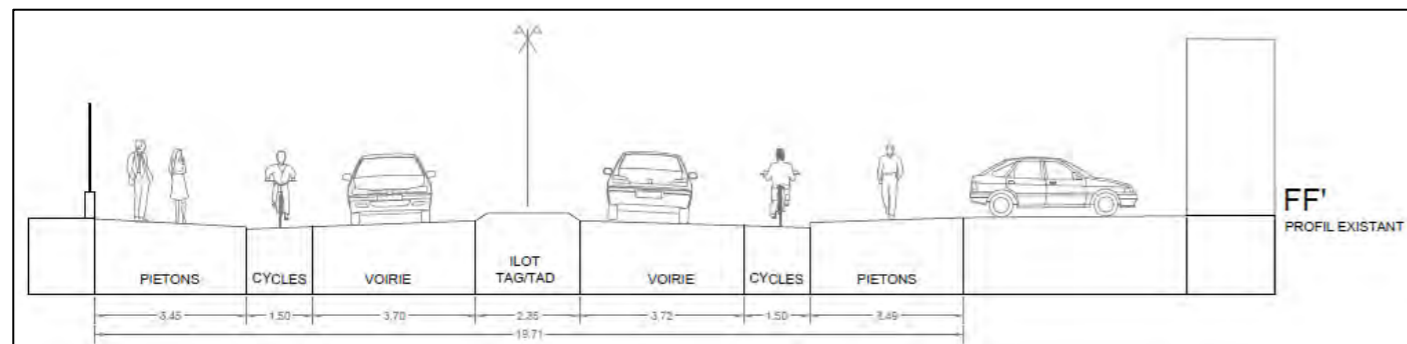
Profil en travers type existant entre la rue du Professeur Villemain et l'avenue Favard
